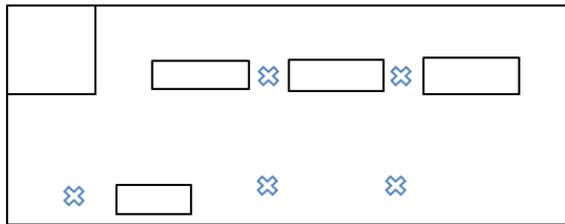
Denah Pencahayaan Pada Gedung Barecore
